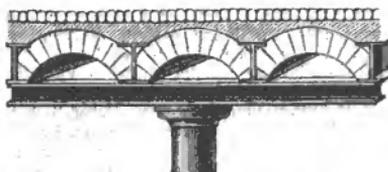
Jauchebehälter mit Backsteingewölben auf Eisenbalken.
